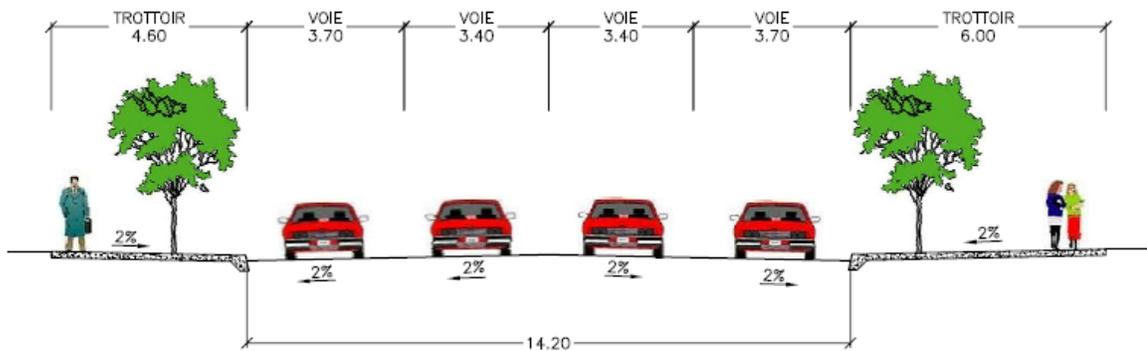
COUPE A-A GAUCHE - AUTOROUTE BONAVENTURE
